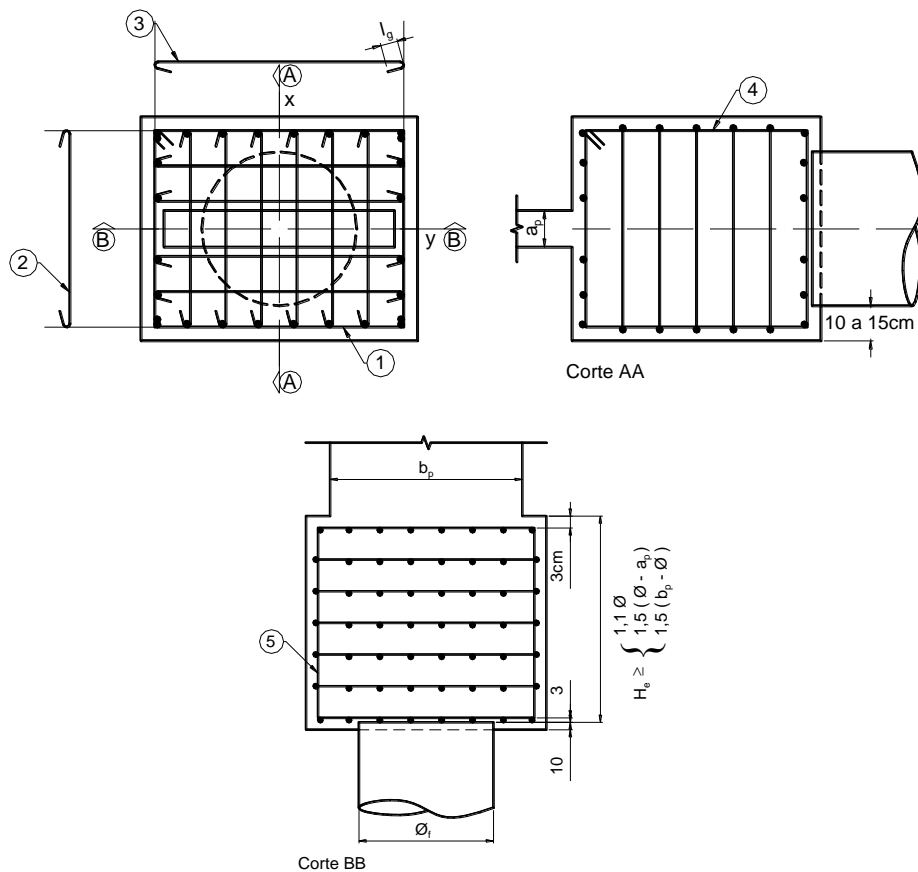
Exemplo de detalhamento das armaduras para o bloco de transição.
